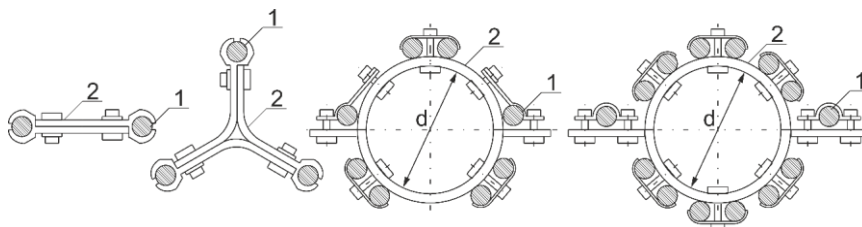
Провода расщепленной фазы и гибкие подвесные токопровод: 1 – несущий провод; 2 – крепежная арматура.
